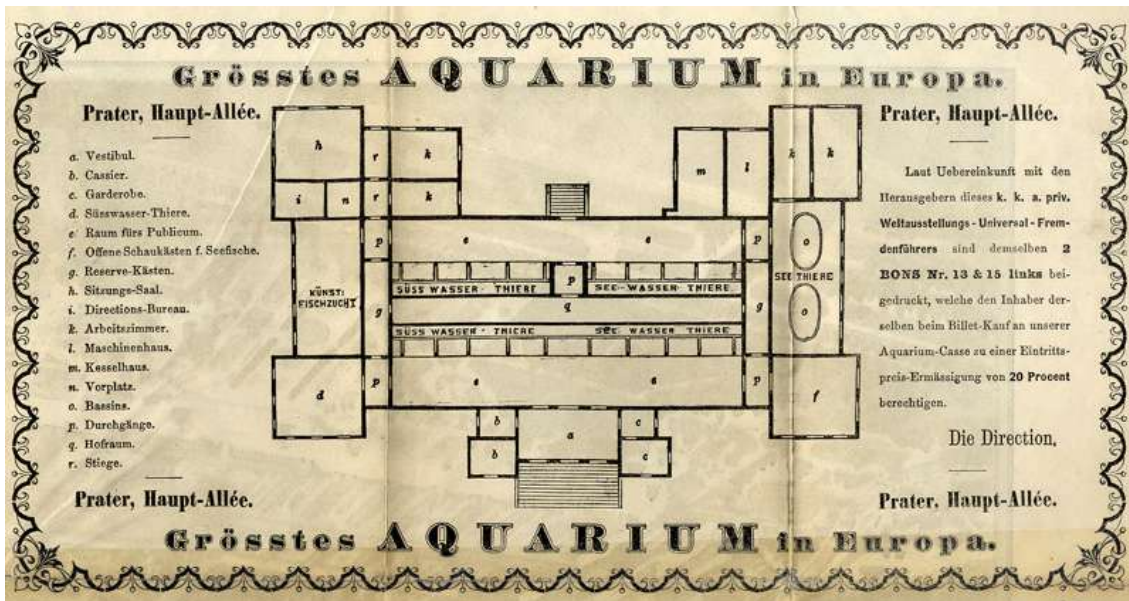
Grundrissplan des Wiener Aquariums, 1873
